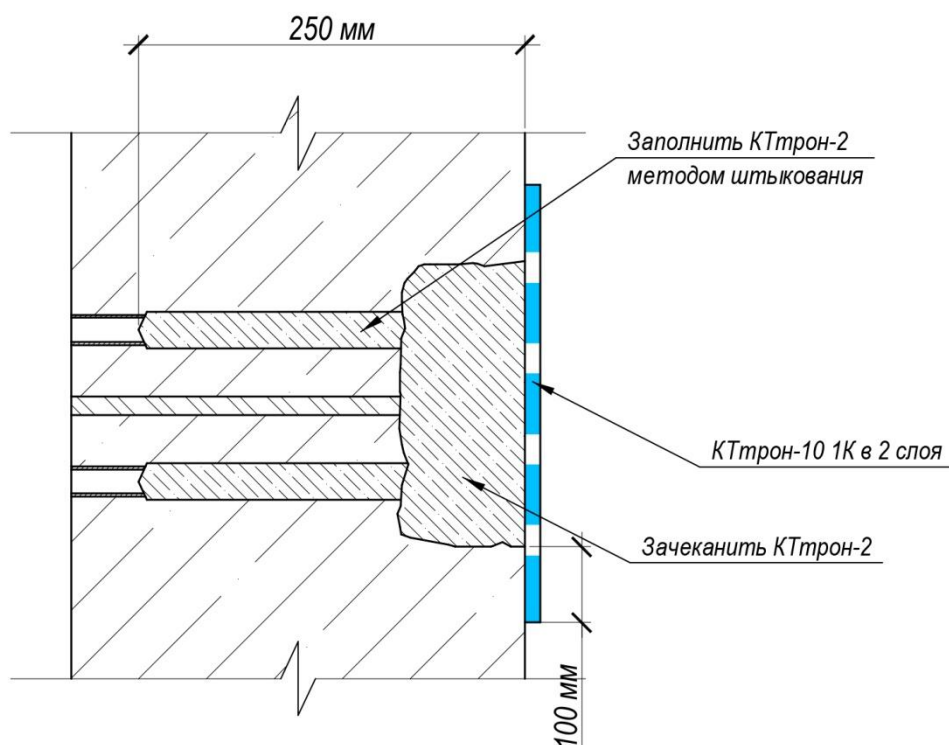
Рекомендации по проведению гидроизоляционных работ.
